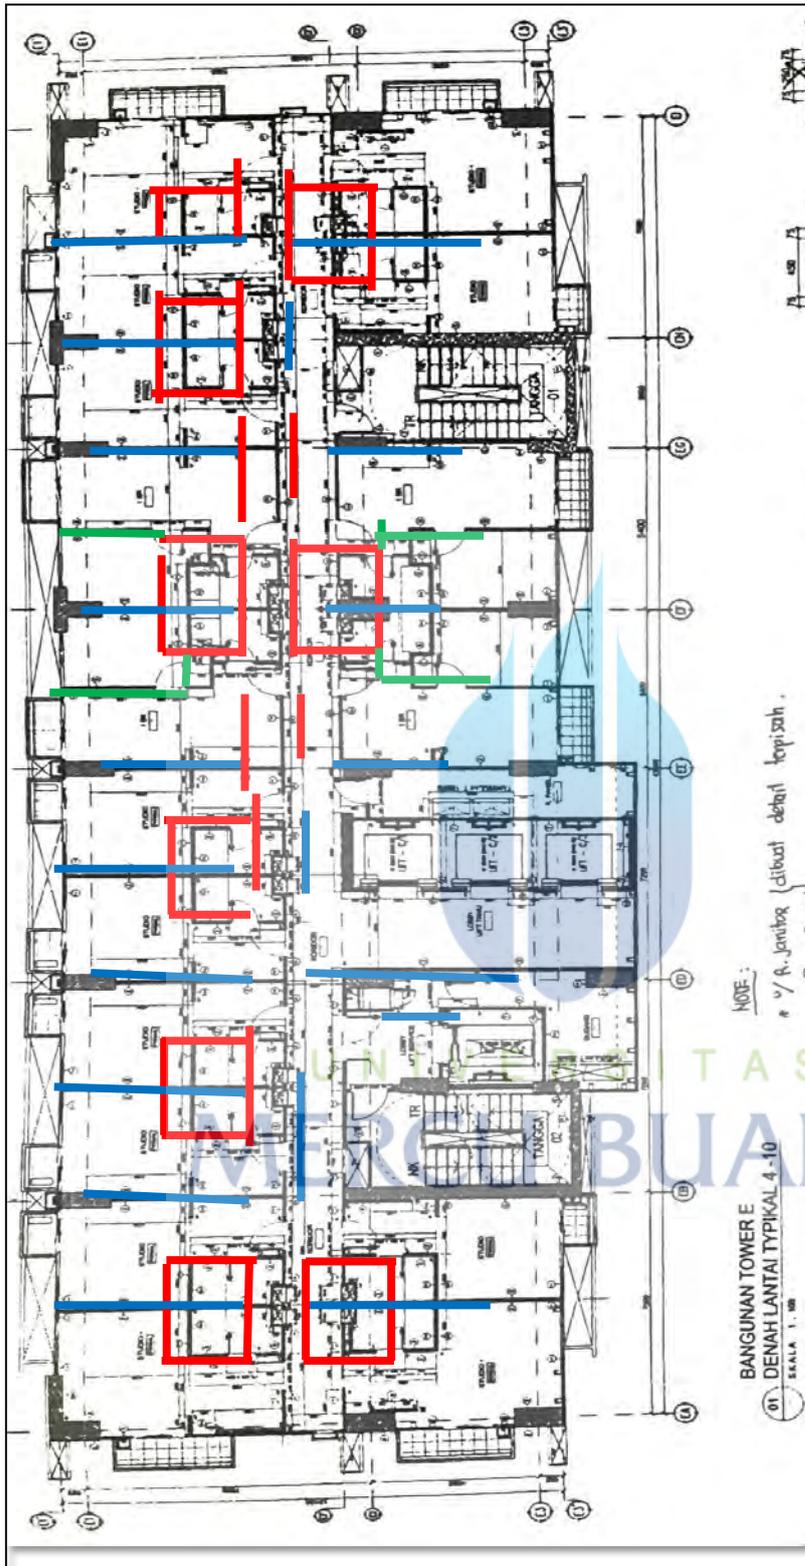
Denah Pekerjaan Dinding lantai 2
